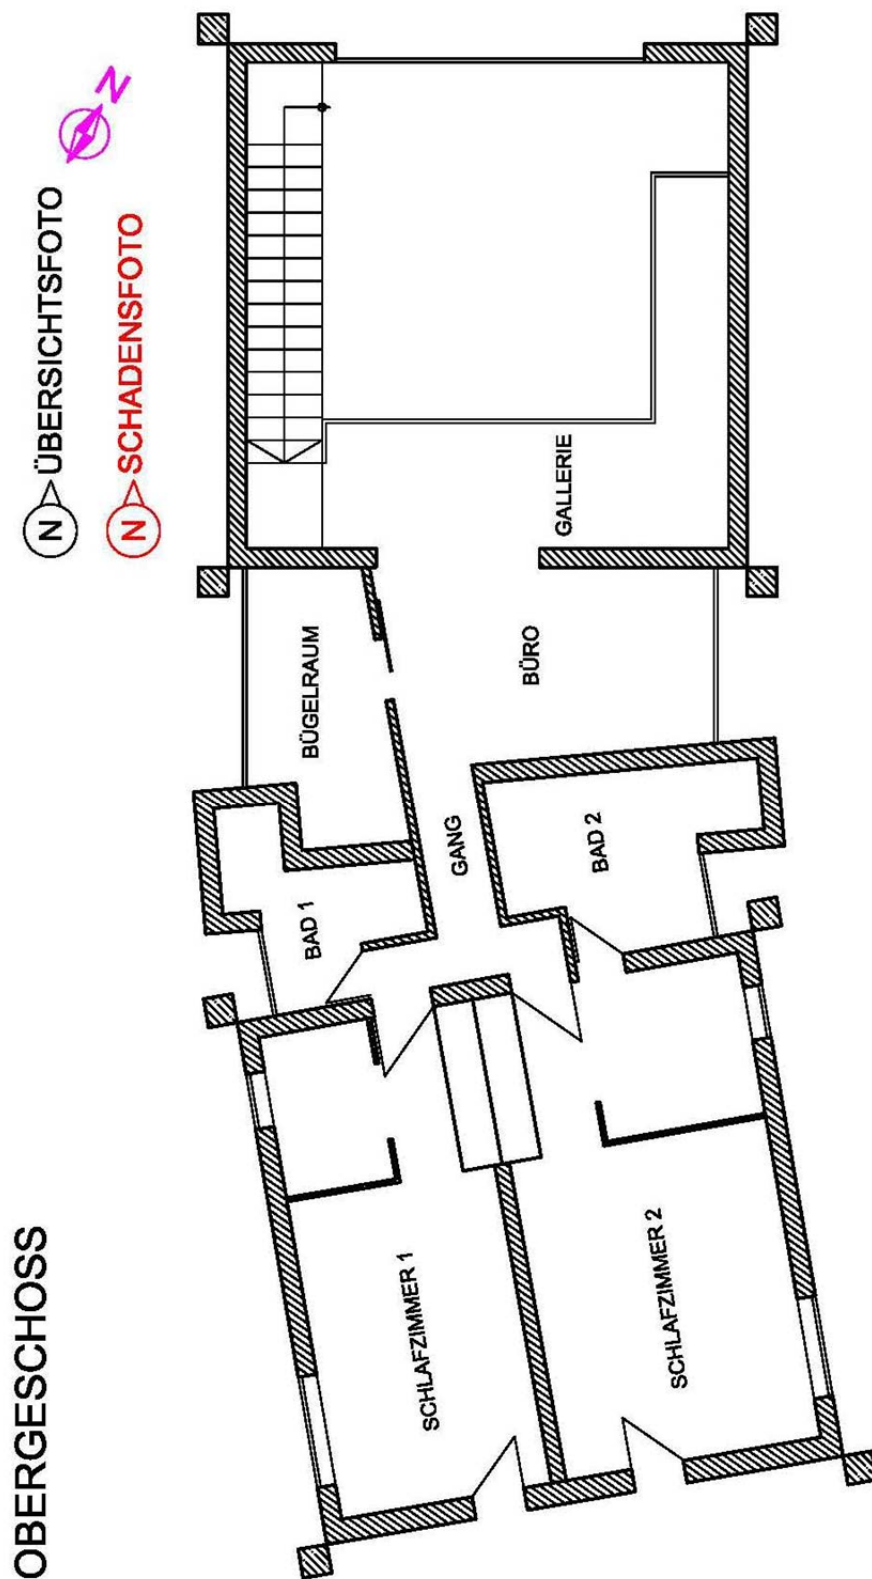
Beispiel einer CAD mäßigen Aufbereitung eines Grundrissplanes
